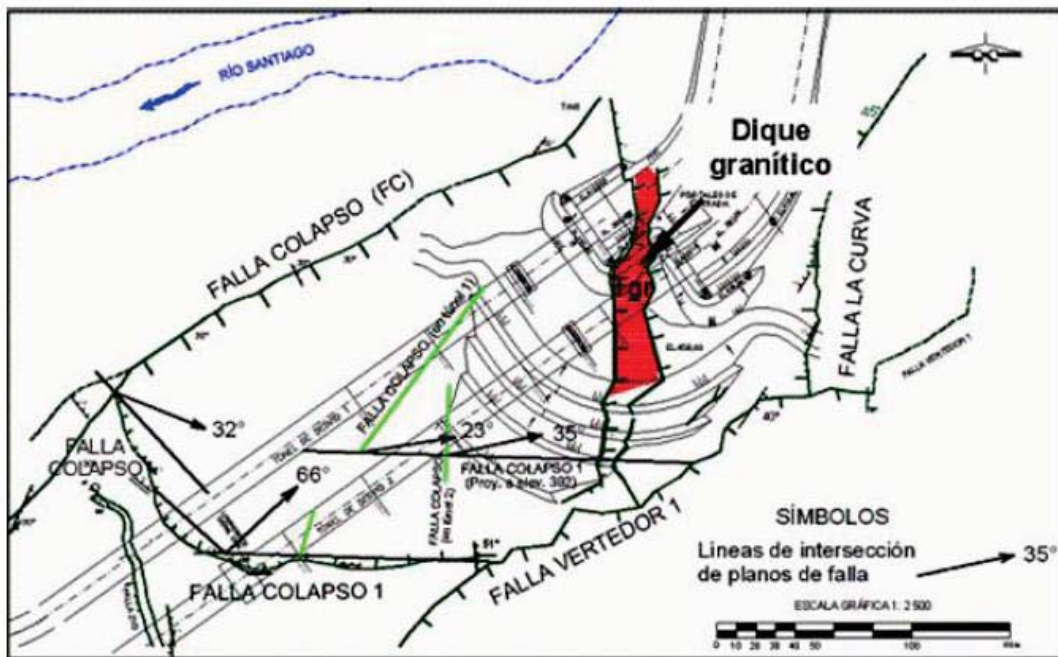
5 Planta estructural de la margen izquierda del P.H. La Yesca, se ilustran las principales fallas que delimitan el bloque inestable, así como las intersecciones entre los planos de falla.
